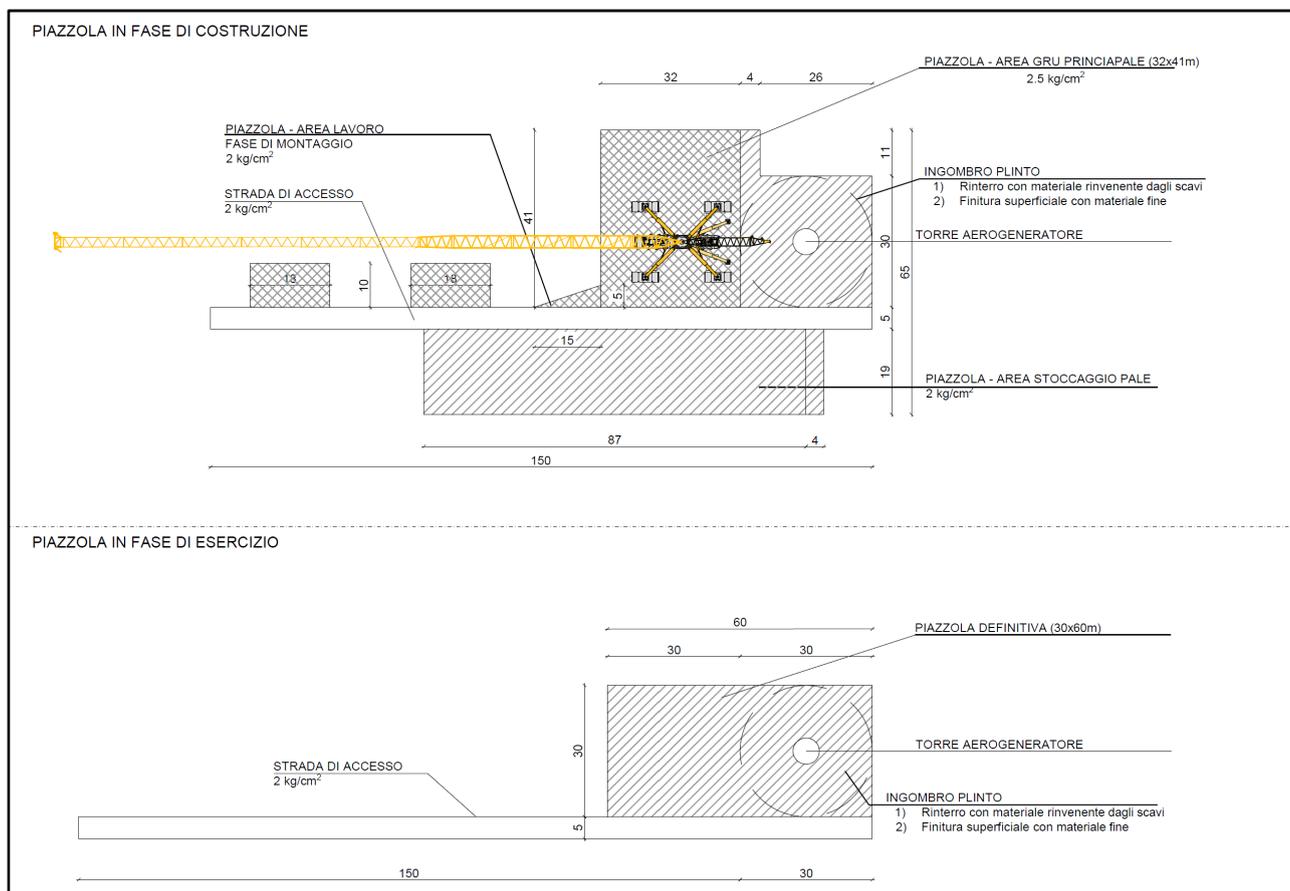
Planimetria piazzola tipo per la fase di costruzione e la fase di esercizio e manutenzione
